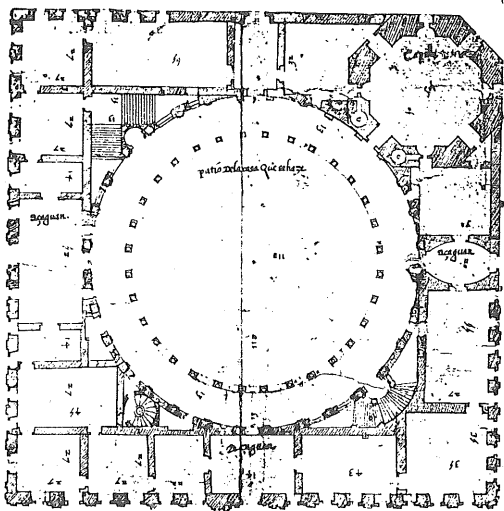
Planta del Palacio por separado. (Detalle del plano de Machuca.)
